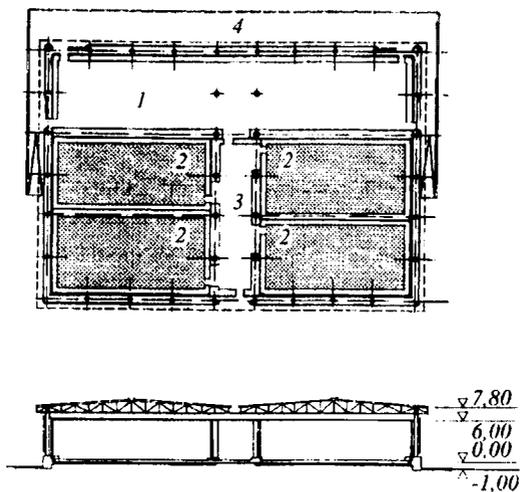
План фруктохранилища вместимостью 1600 т:
